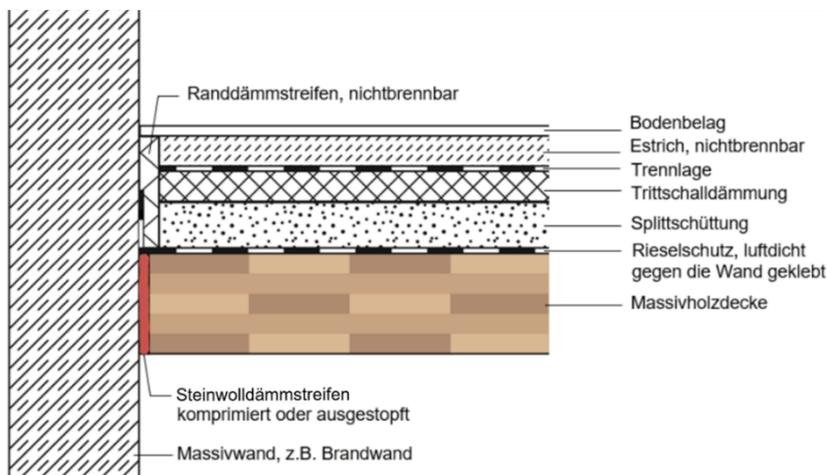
Bauteilanschluss unbelagte Massivholzdecke an Massivwand (Vertikalschnitt) [Muster-Richtlinie 23.05.19]
